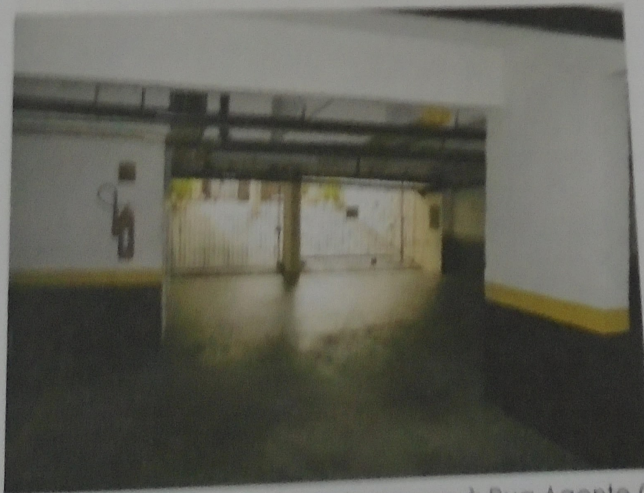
Garagem com vista dos portões de acesso à Rua Agente Gomes - 1º subsolo
